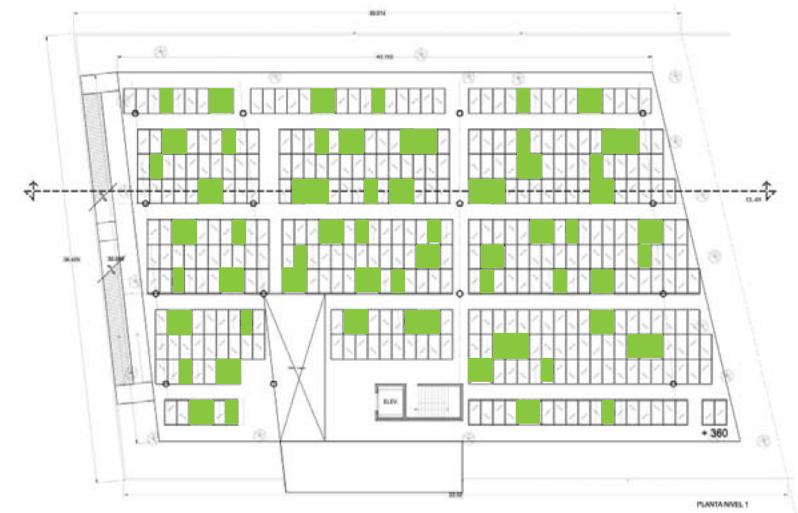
• Planta arquitectónica Nivel 2. Cementerio Judío.
